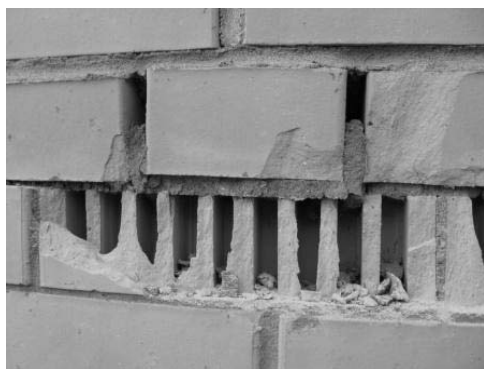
Деформация лицевого кирпича наружной стены жилого дома
